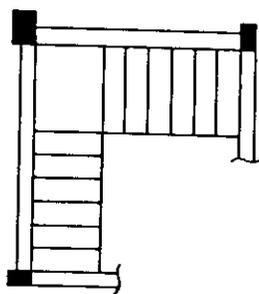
Escada em "I" com 4 vigas no contorno
